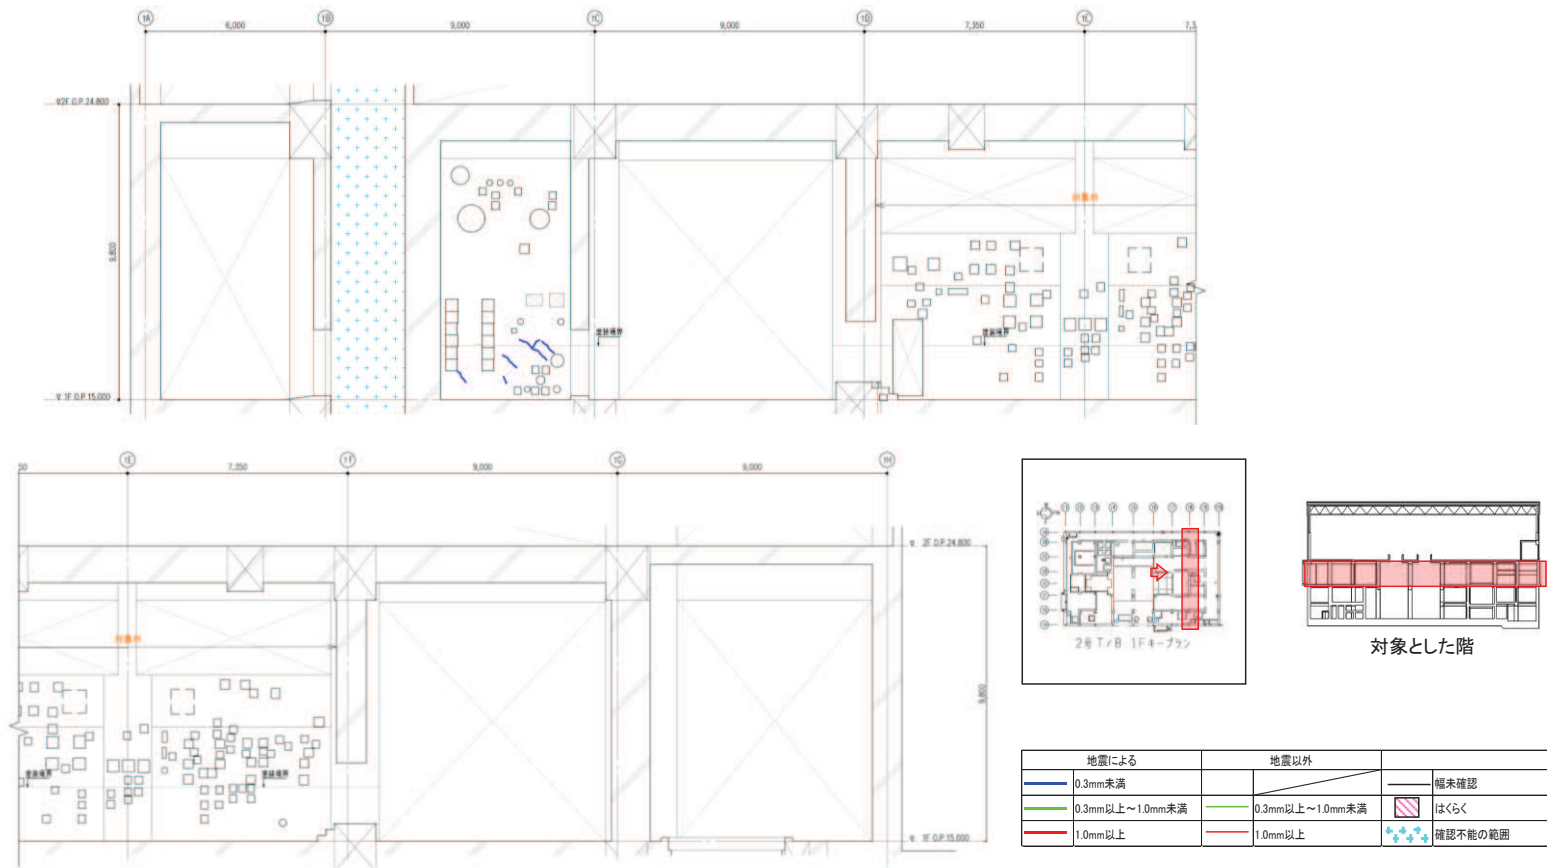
タービン建屋のひび割れ分布 耐震壁 (40) 1階 T8 通り
